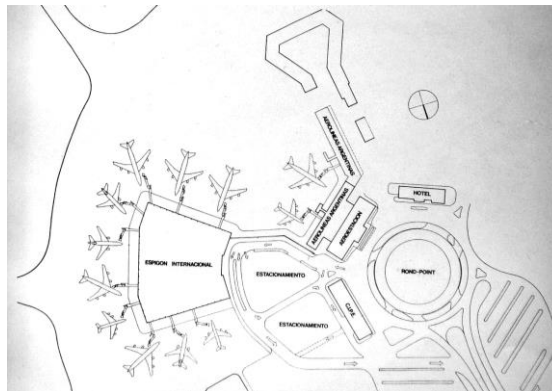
Planta general de las terminales Fuente: Revista Construcciones n° 268
